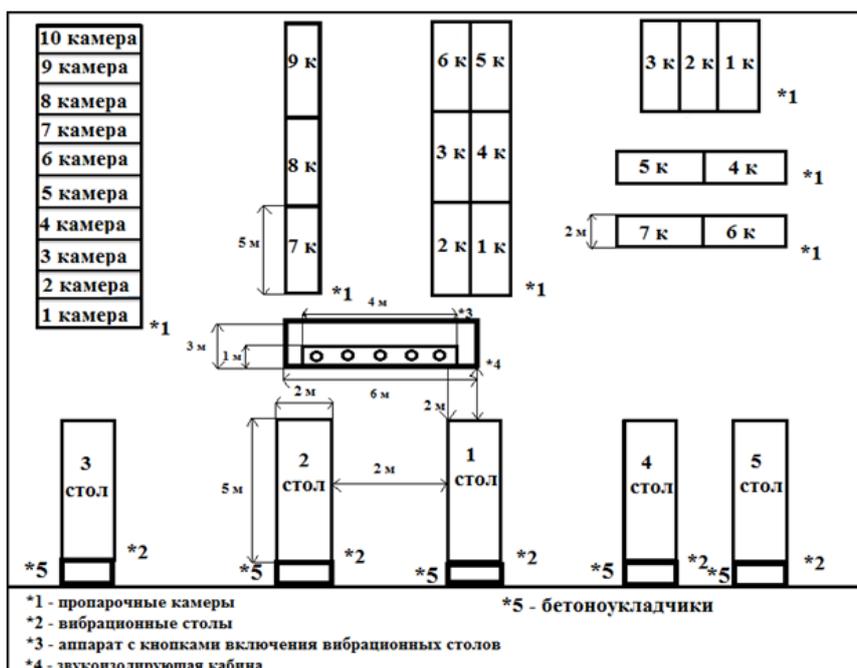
Схема формовочного цеха с установленной звукоизолирующей кабиной
